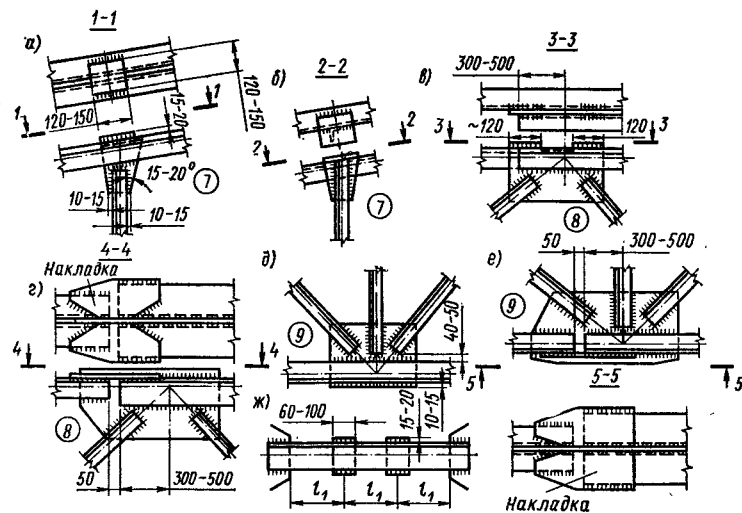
Промежуточные узлы типовых унифицированных ферм (а—е) и устройство соединительных планок в элементах ферм
